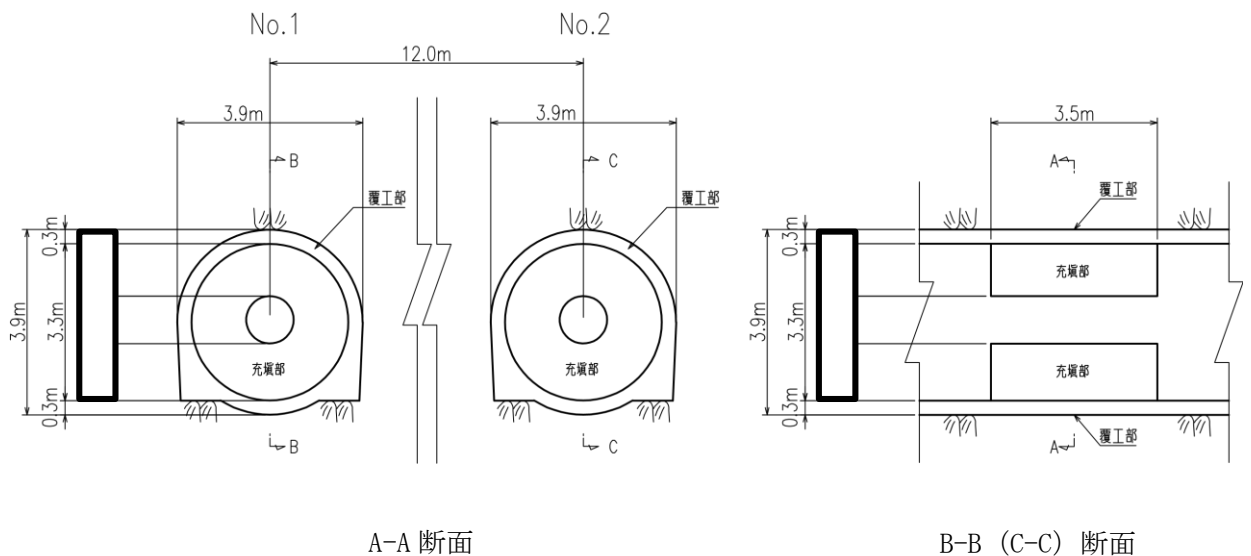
(2) 取放水路流路縮小工（第1号機取水路）(No. 1), (No. 2) 断面図
